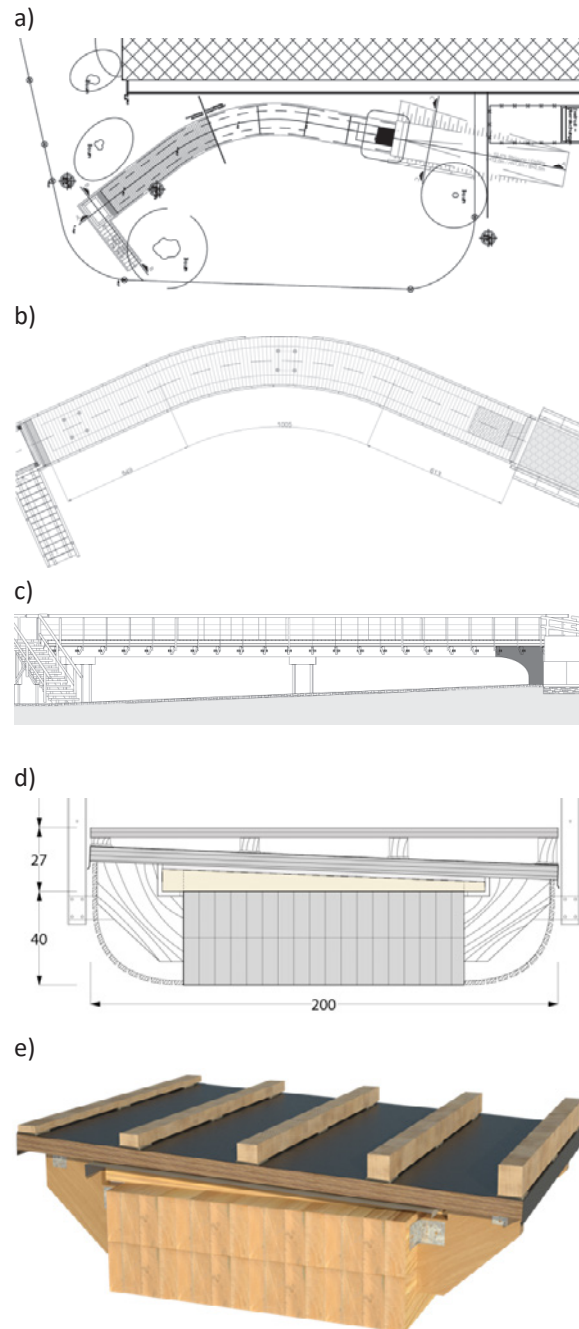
Lageplan, Ansichten und Abmessungen der auf dem Campus der Universität Stuttgart gebauten Stuttgarter Brücke
